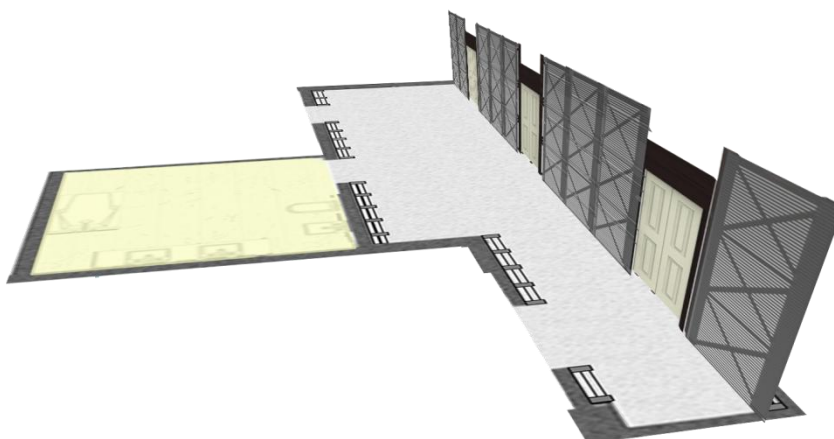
Desenho esquemático com vista interior de corredor e casa de banho em render, criação do autor.
